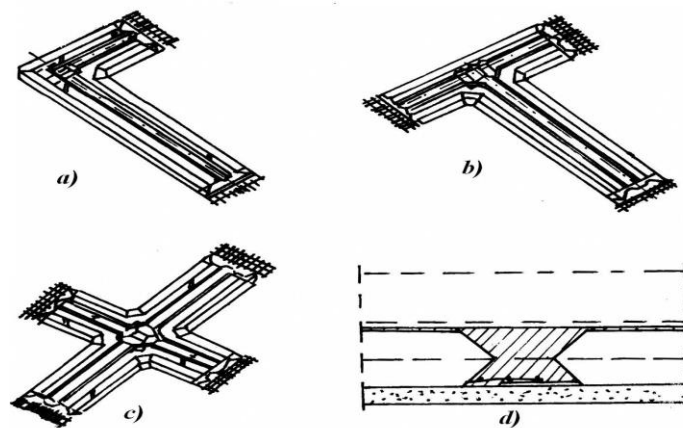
Elemente prefabricate a) element L; b) element T; c) element X; d) îmbinarea elementelor de talpă.
